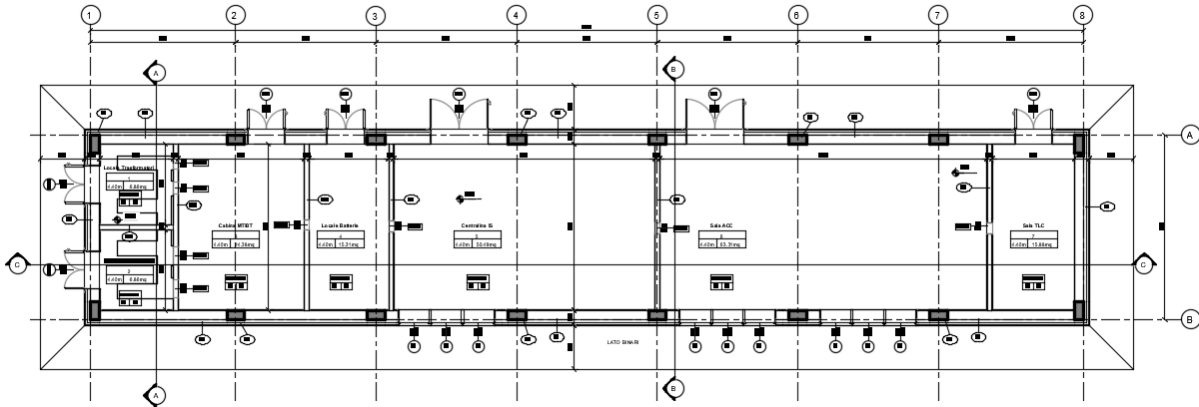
pianta tipologica fabbricati tecnologici FA01 e FA02
